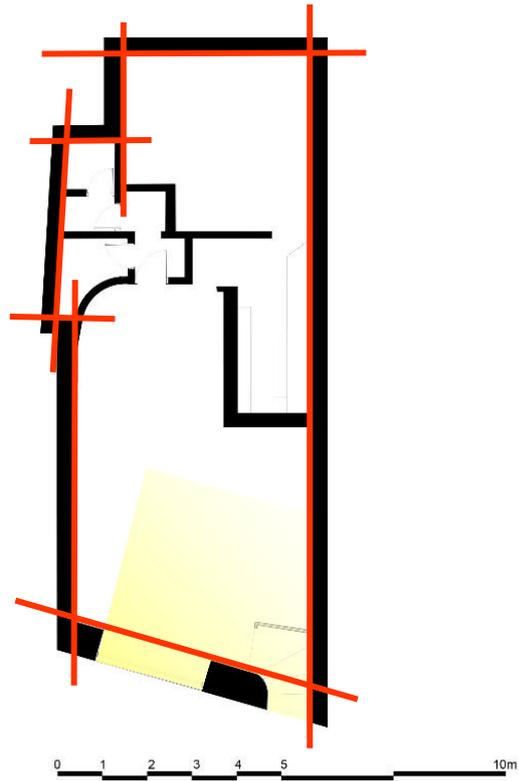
Planta baixa da loja 3 com marcação esquemática das paredes principais e da entrada de luz
